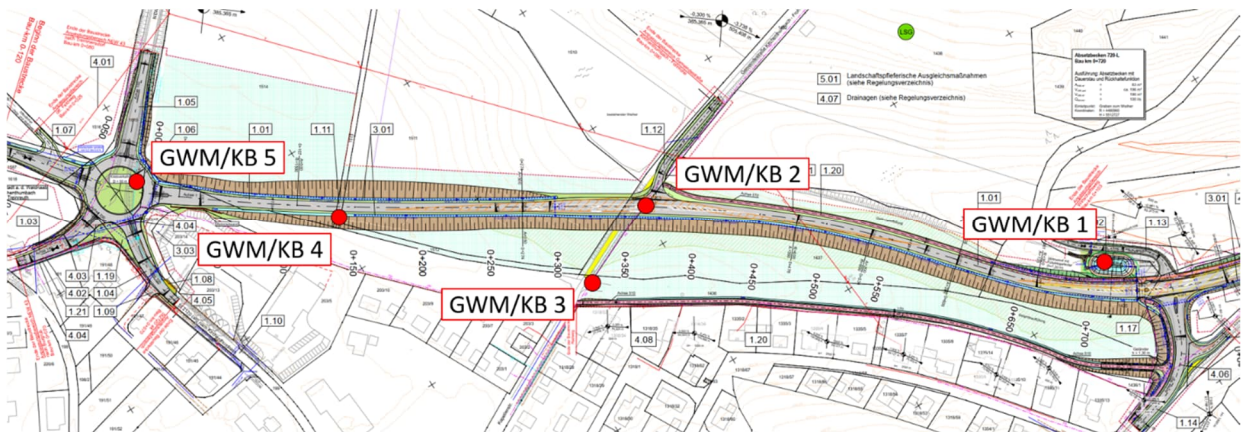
Standorte der Kernbohrungen (KB) und Grundwassermessstellen (GWM)
